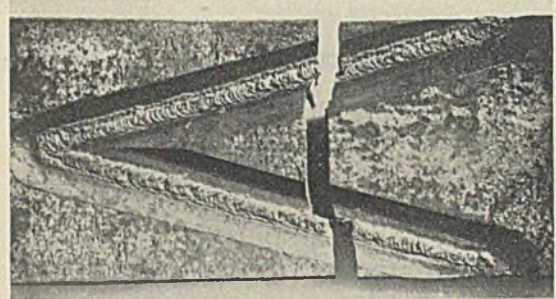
Bruchausbildung, von der Seite der V-Naht gesehen. Bruchlast 496 t.
